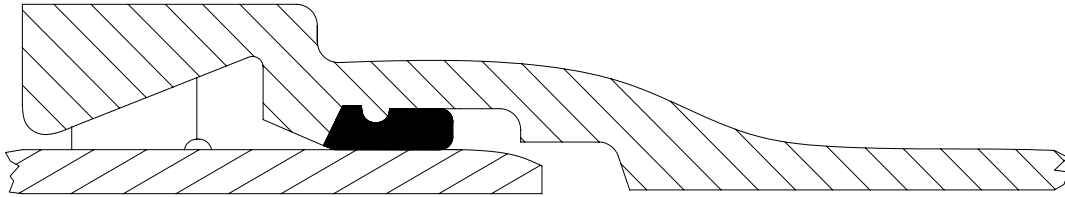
CONDUITES EN PVC-U OU EN PVC-O — JOINT À EMBOITEMENT
